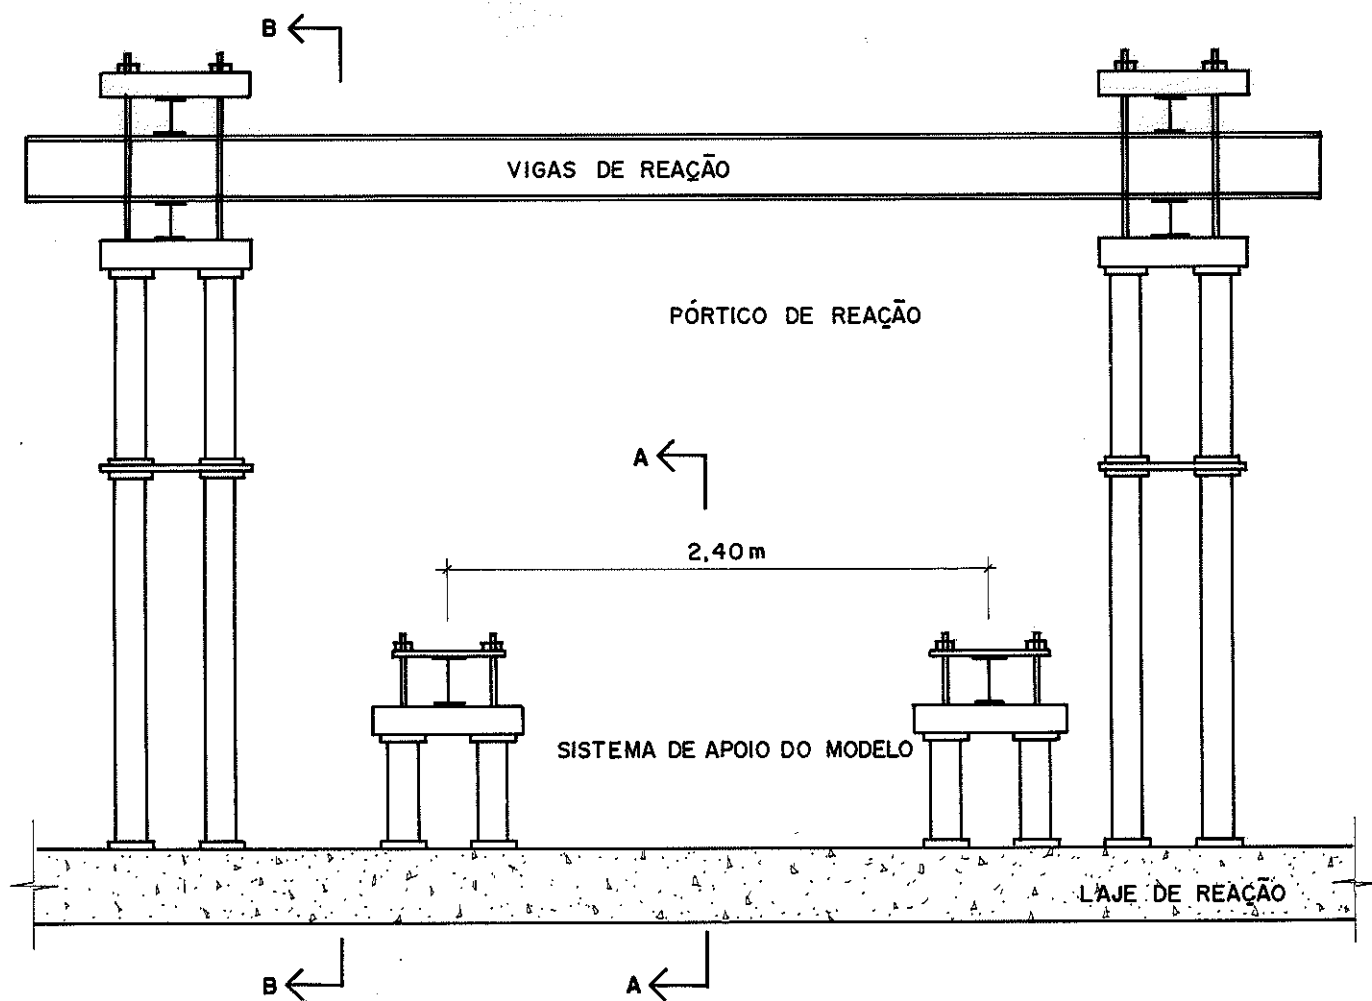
A- Sistema de apoio, pórtico e laje de reação
